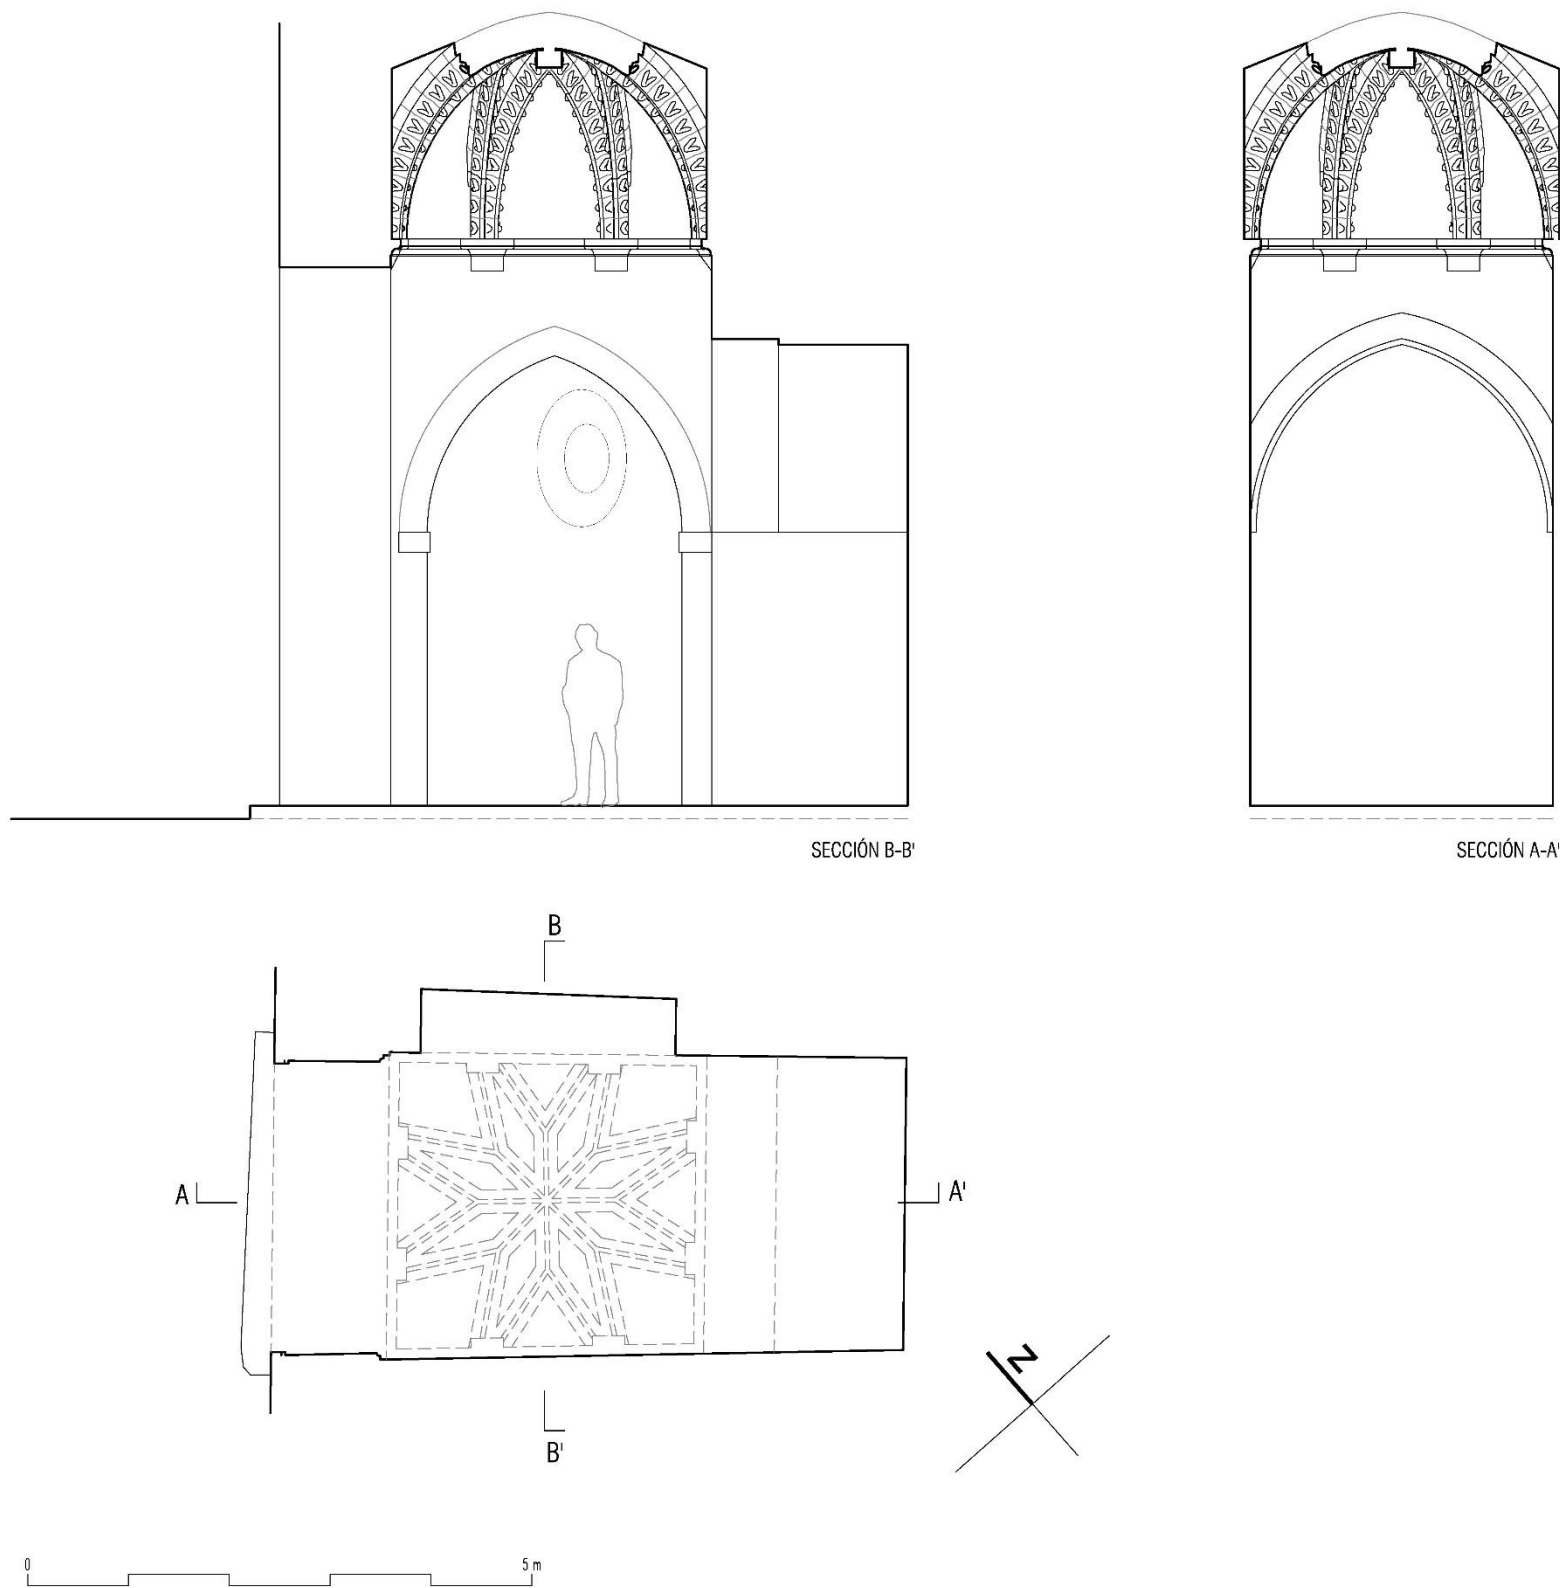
Planta y secciones. Capilla Suárez de Toledo. San Mateo. Jerez.
